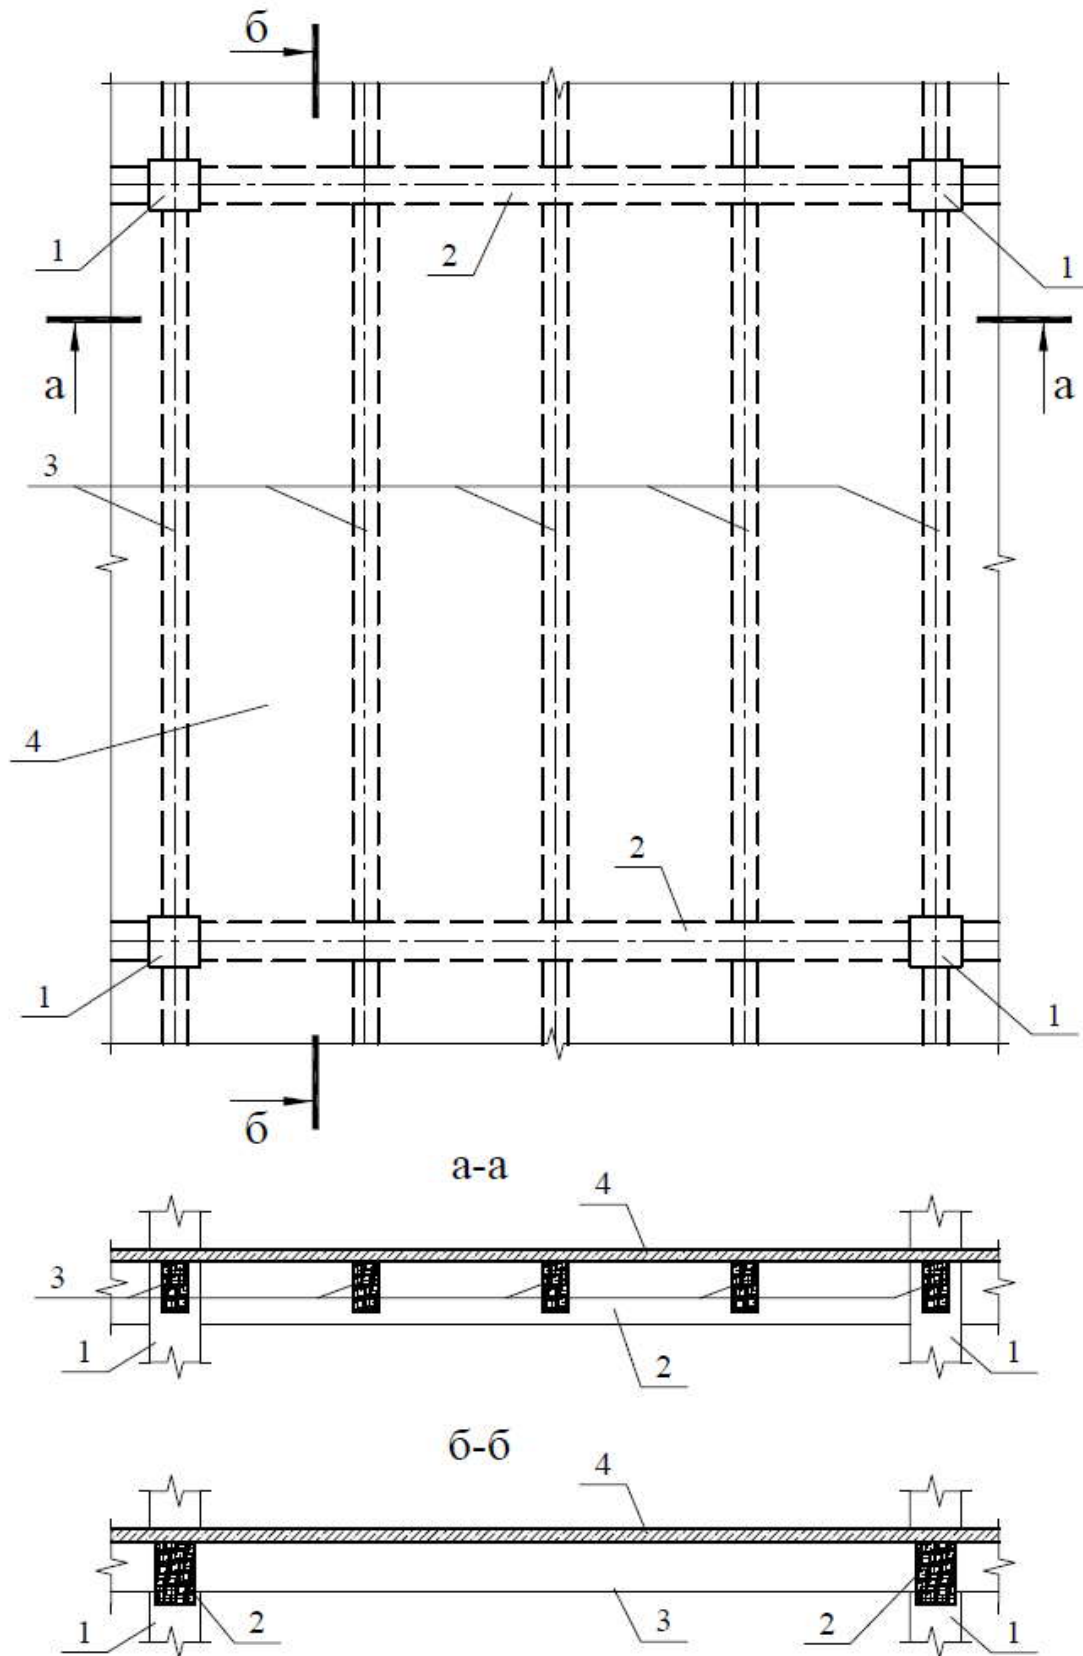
Схема збірно-монолітного гібридного деревозалізобетонного перекриття: 1 – колони; 2 – головні балки; 3 – другорядні балки; 4 – монолітна залізобетонна або армована ґрунтобетонна плита
